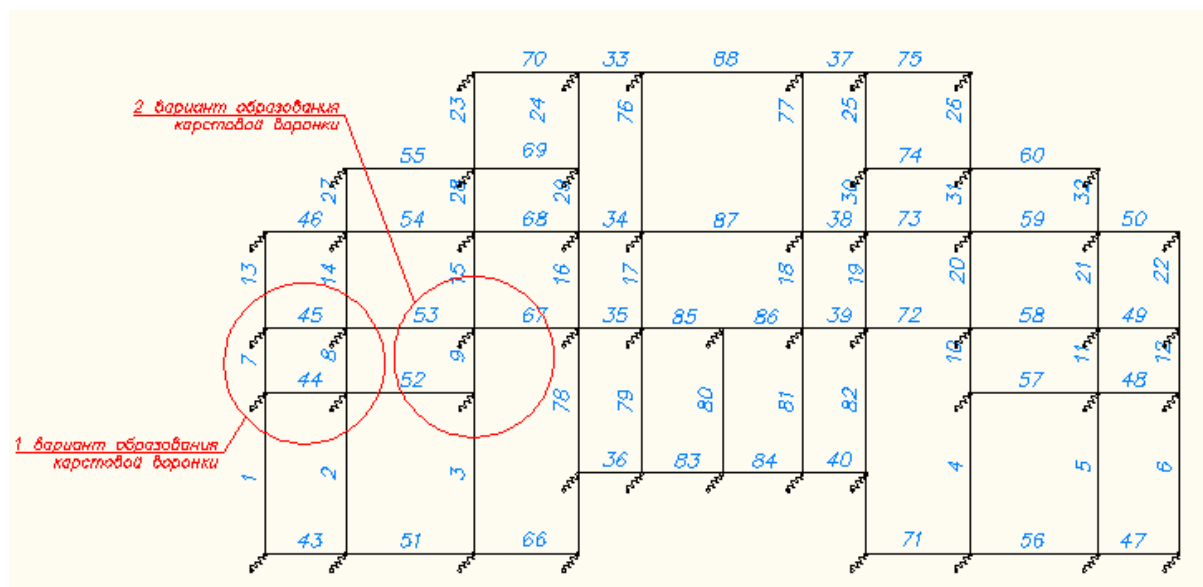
Расчетная схема фундамента в виде монолитных продольных и поперечных лент с номерами конечных элементов
